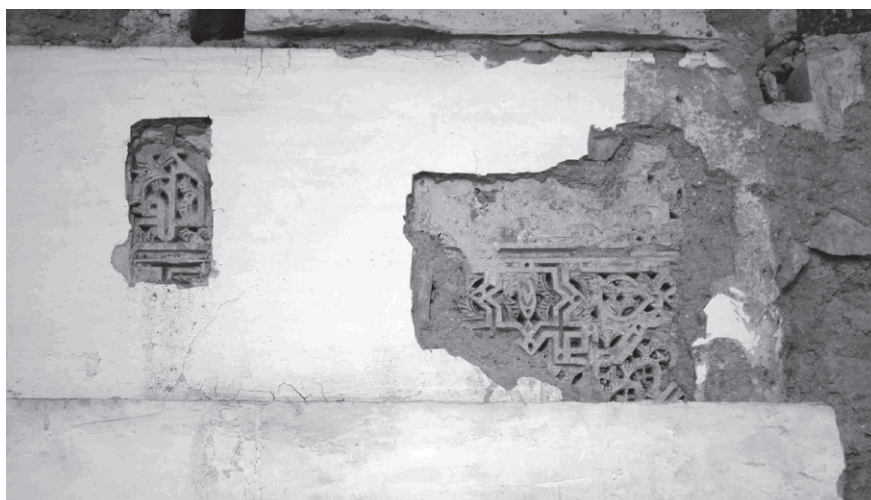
Detalle de una yasería del salón norte del convento de Santa Clara de Sevilla
